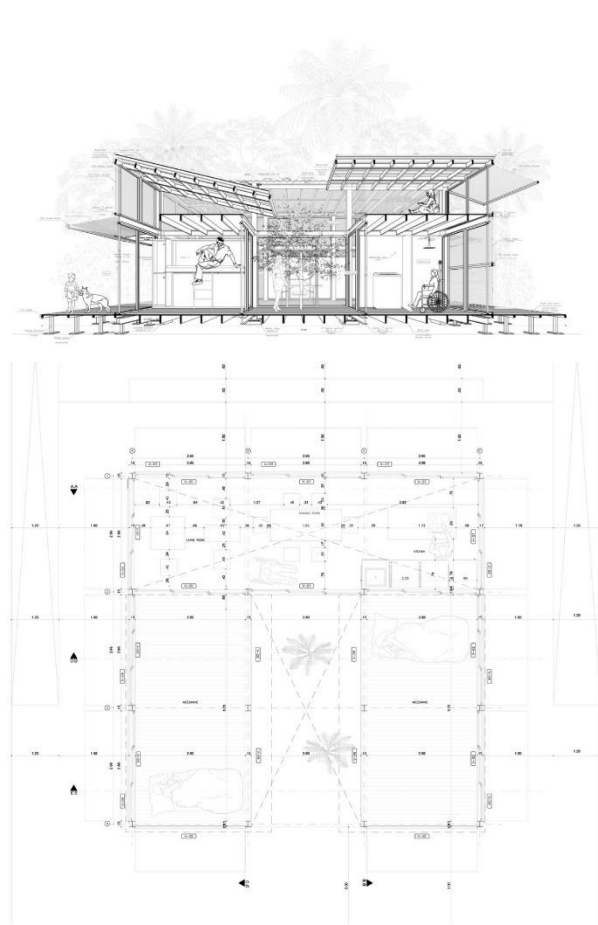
Planimetría de la propuesta de vivienda social bajo parámetros de sostenibilidad para el sector de El Pozón. Se configura sobre una planta cuadrada compuesta por las dimensiones de dos lotes del sector, es decir, existen dos viviendas en un mismo plano, dispuesto entorno a un patio interior enlazado a uno de los lados del cuadrado. Sobre este se articulan los espacios privados enfrentados y paralelos al patio. El área social es de doble altura, con posibilidad de aprovechamiento y/o progresividad, dispuesto de manera perpendicular al patio. La planta construida conforma una "U" que se abre al exterior por medio del patio o con el módulo de áreas sociales (Baraya, 2020).
